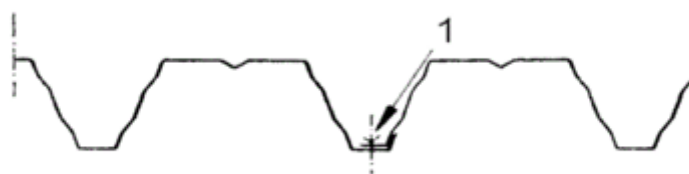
Schéma pokládky trapézových plechů na hale objektu
